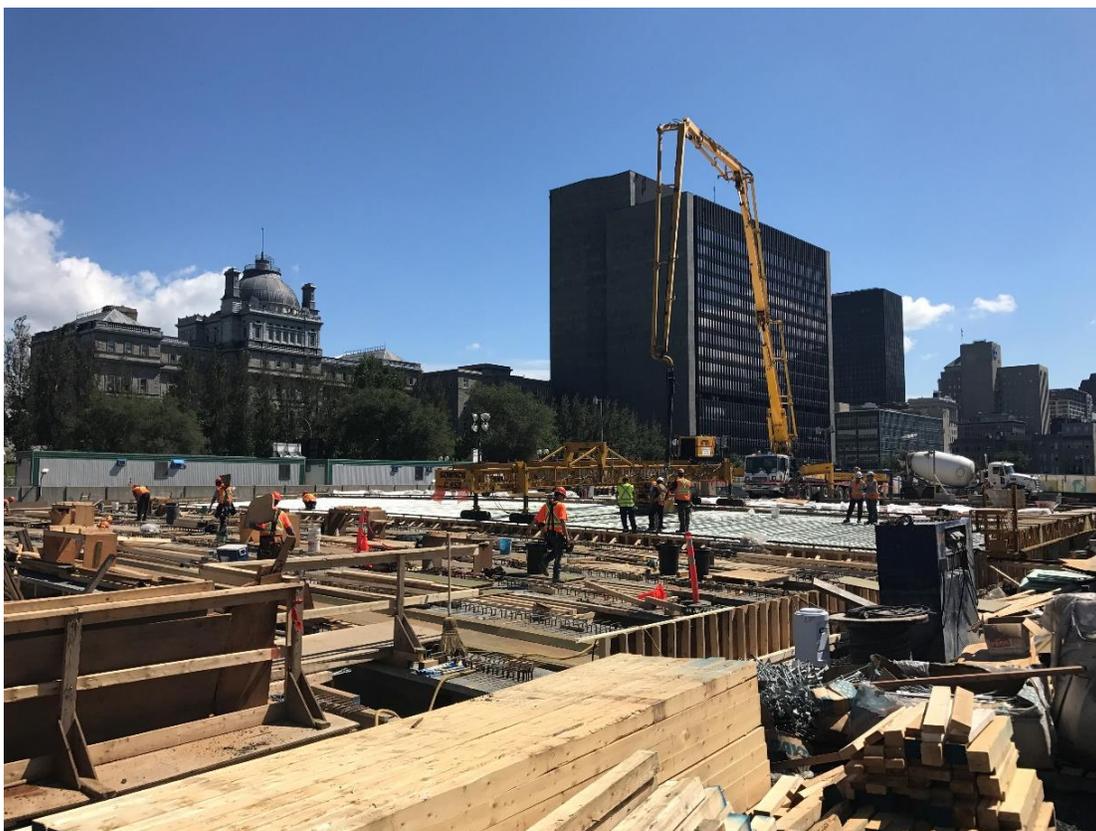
Travaux de construction des différentes sections de dalle de la structure
